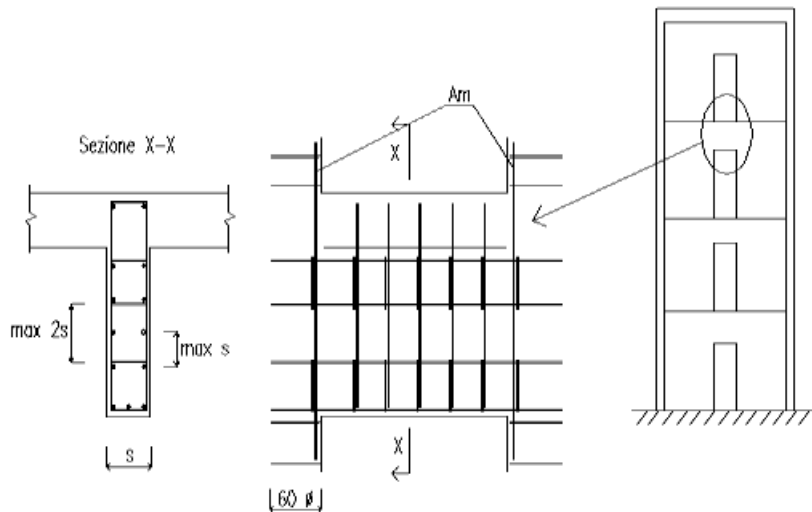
Armatura tipica per collegamenti tra mensole verticali (setti sottili).
